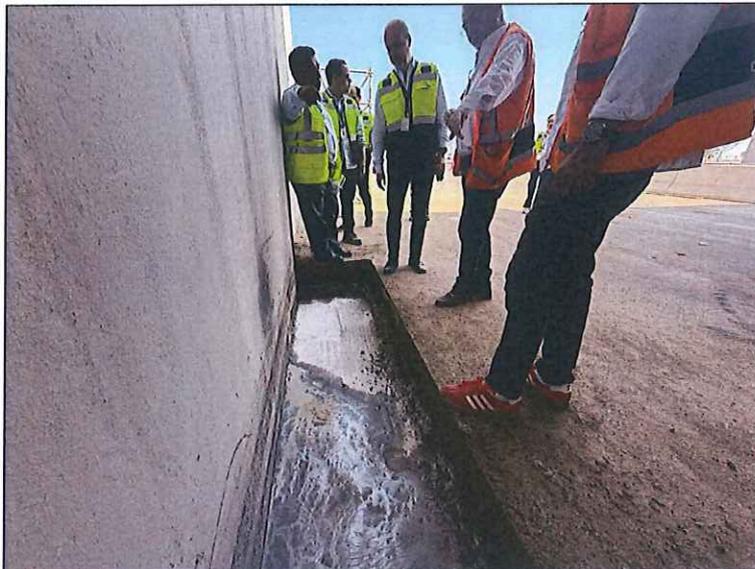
Paso inferior Santa Rosa – Se evidenció la presencia de aguas superficiales en contacto con la estructura de pavimento en el corte realizado para la construcción de las canaletas para aguas de escorrentía.
